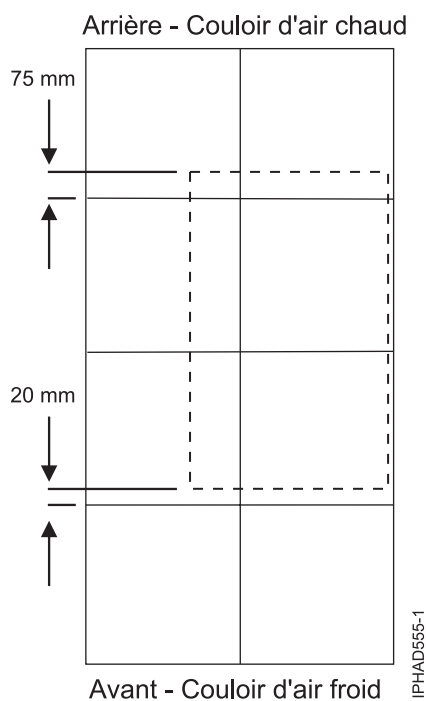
Positionnement de l'armoire pour dalles de plancher de 610 mm
